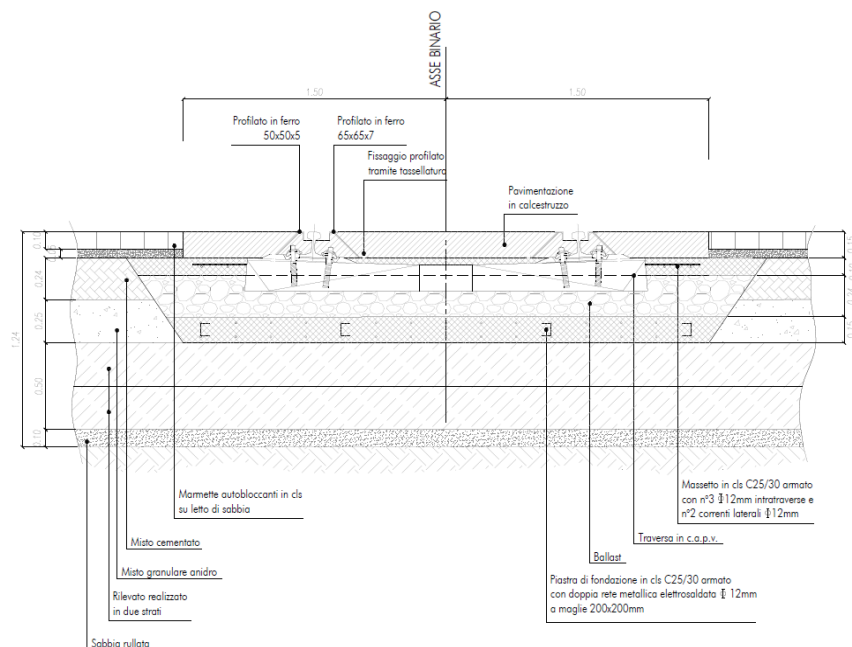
Pacchetti di pavimentazione in progetto – binario carrabile armamento 50UNI
